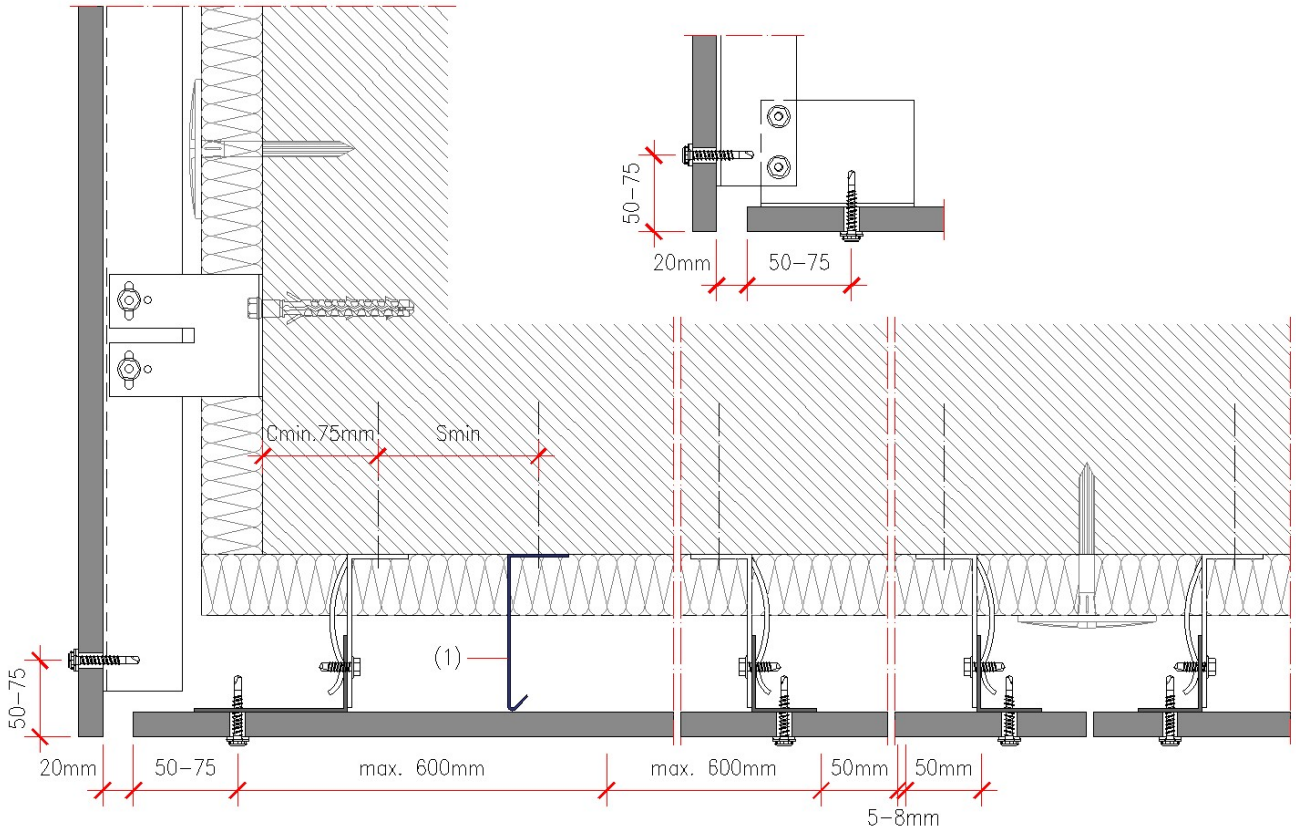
Pormenor da ligação Fachada - Teto falso
